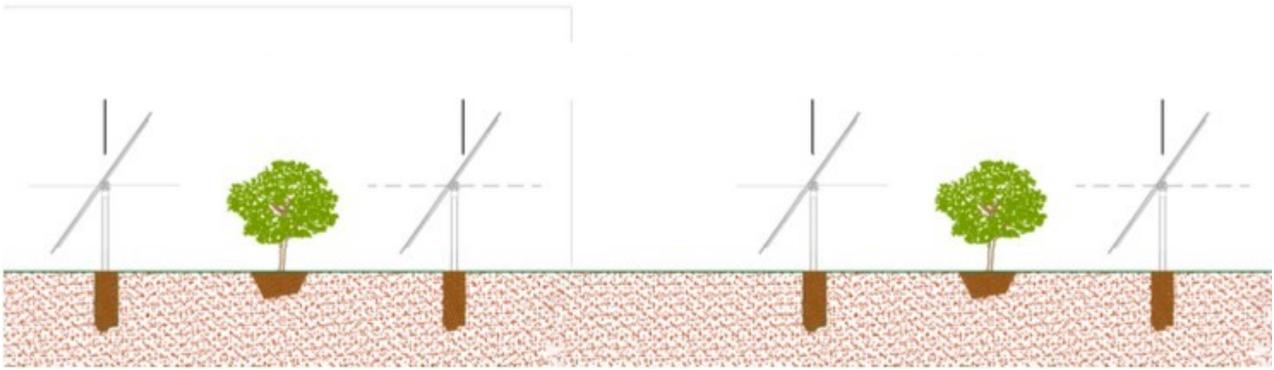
Disposizione oliveto all'interno dell'impianto fotovoltaico oggetto di investimento.
